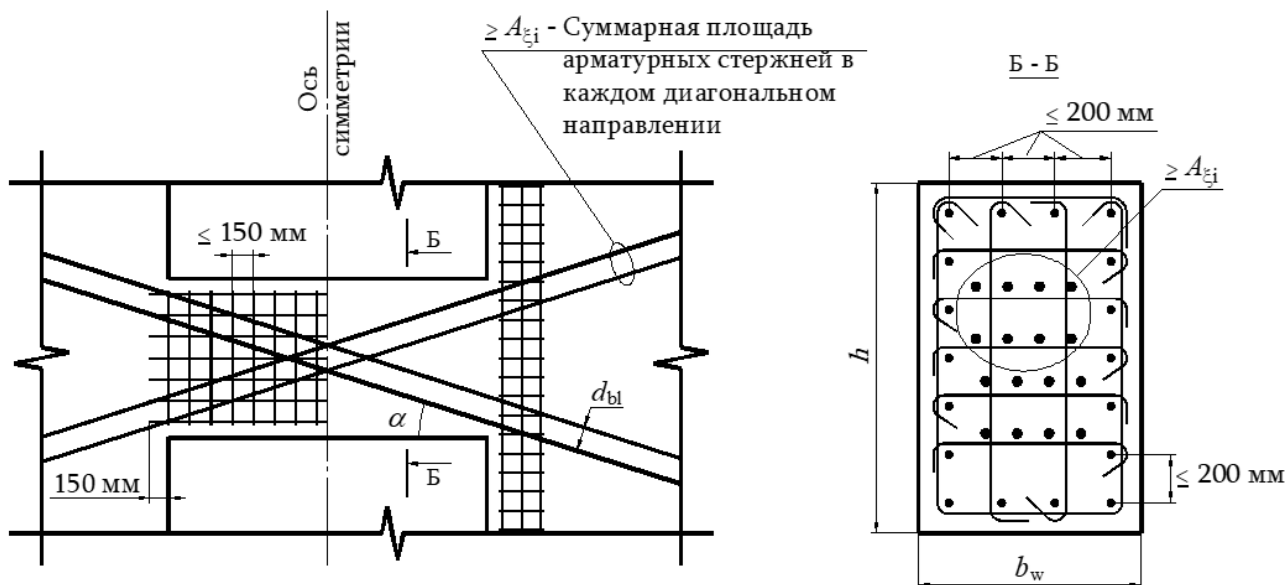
Связующие балки с диагональным армированием по пункту 5.9.5
